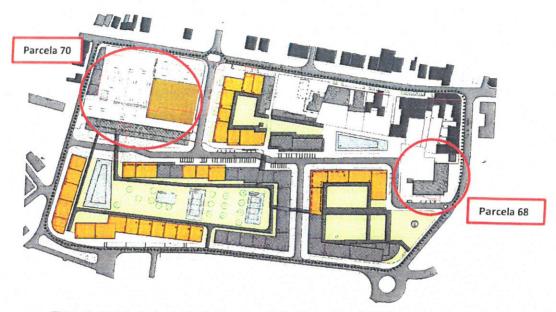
Planta de Implantação da proposta de Alteração do PPSS\_Junho2019
